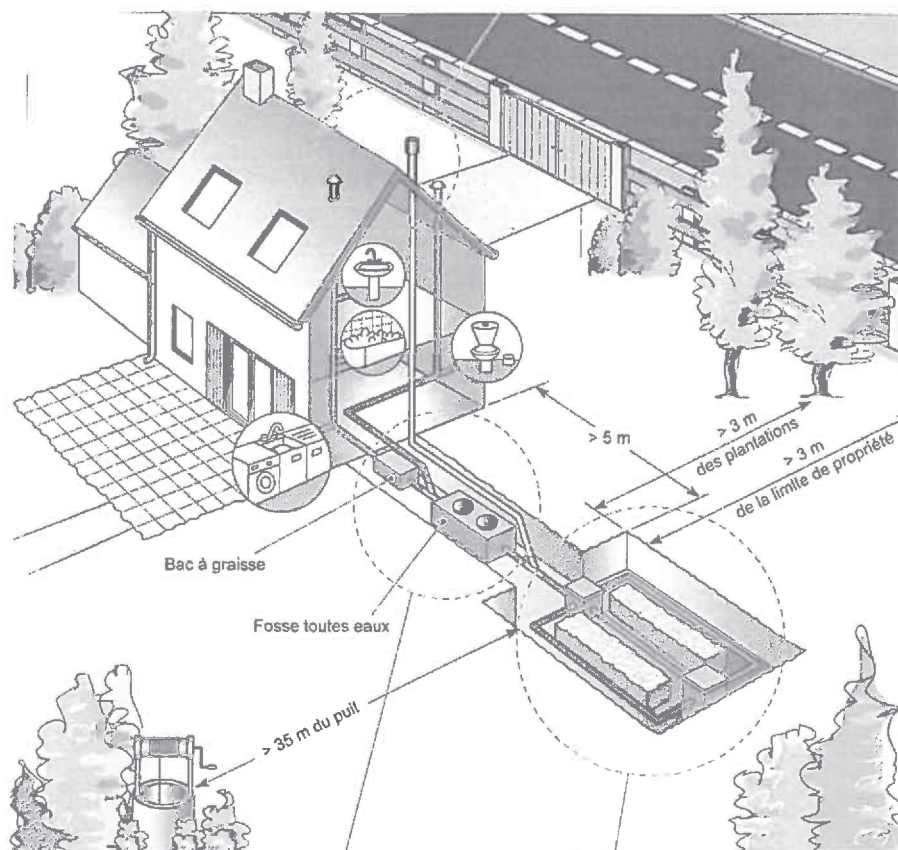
Schéma d'installation d'un assainissement individuel avec tranchées filtrantes
